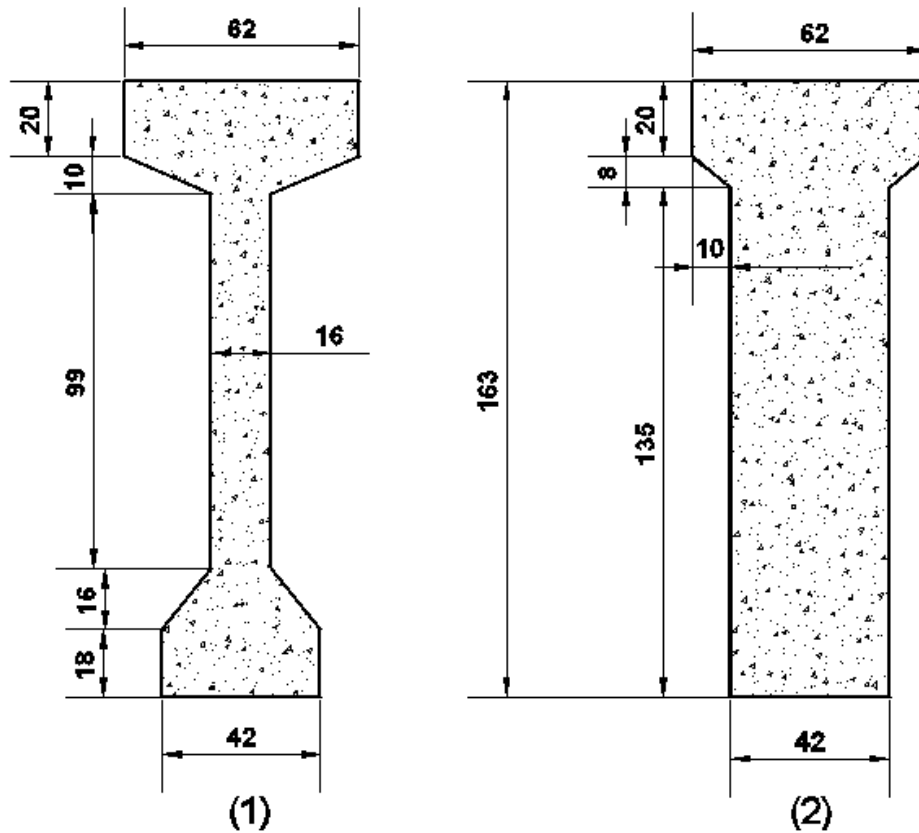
(1) Sección de la viga en la luz. (2) Sección transversal de la viga en los apoyos.
